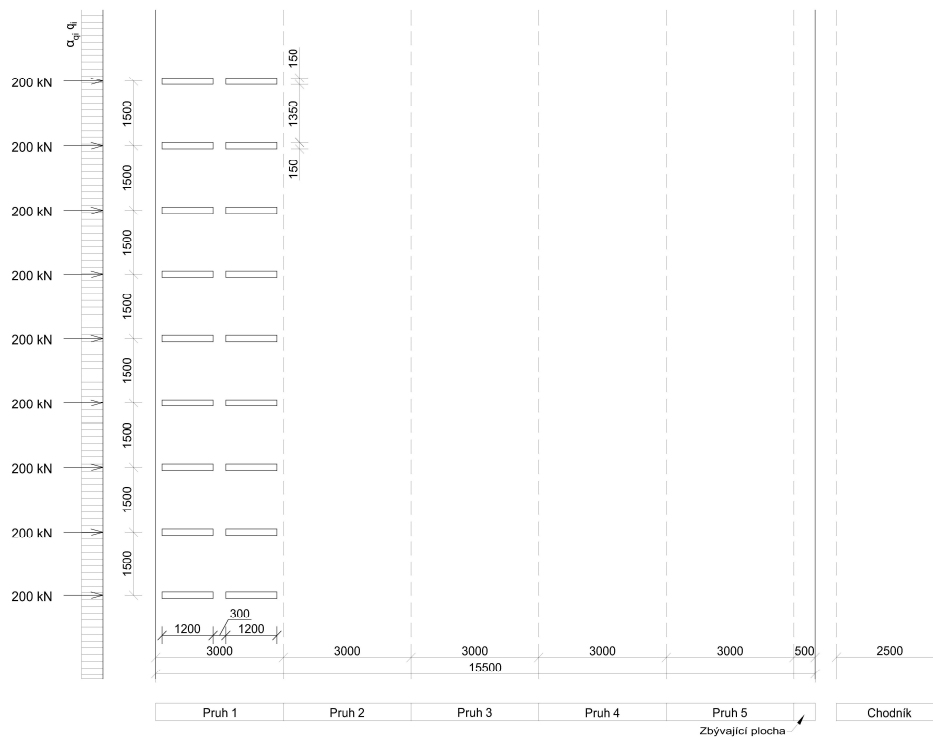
Půdorys - umístění zatěžovacího modelu LM1
